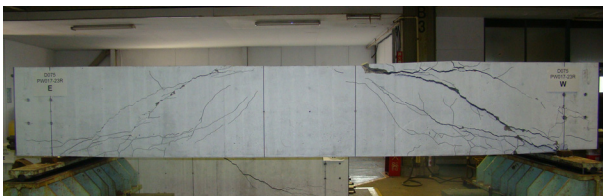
実験終了後のひびわれ状況 (D075PW013-23)
